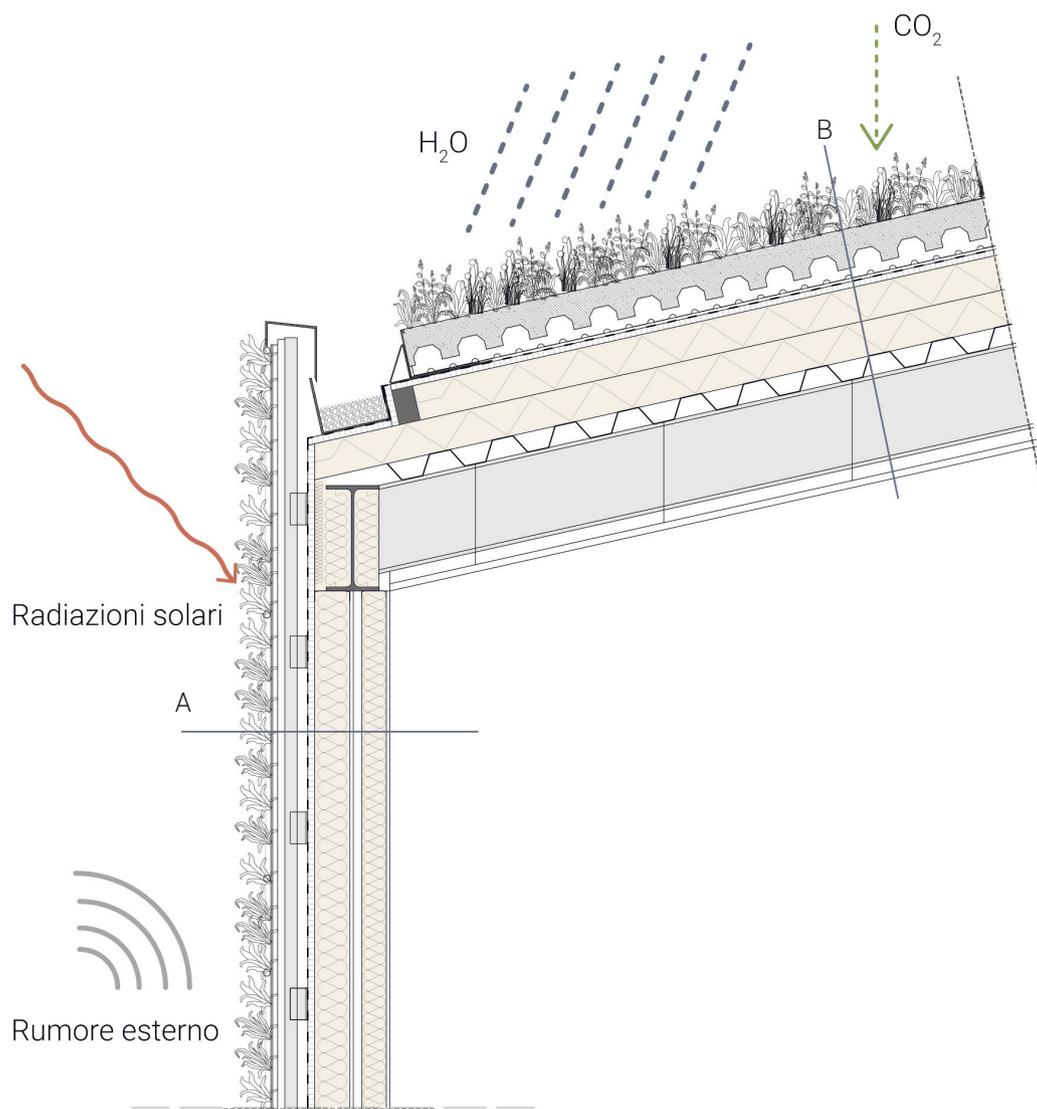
Sezione del nodo parete-solaio di copertura verdi
